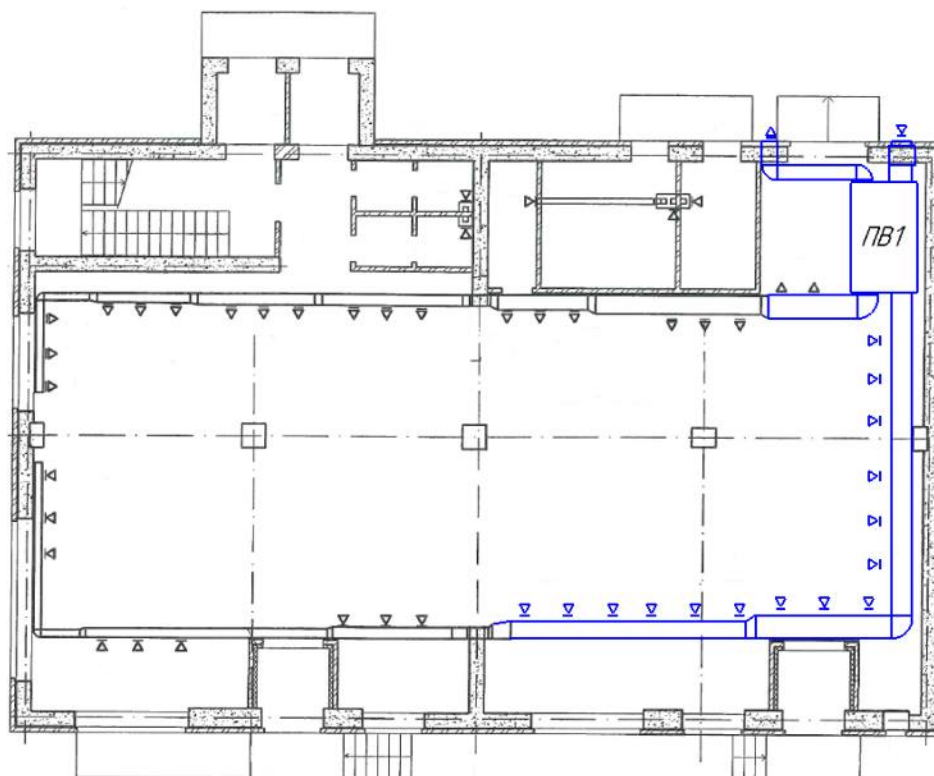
Схема вентиляции первого этажа после внедрения рекуперативной установки
